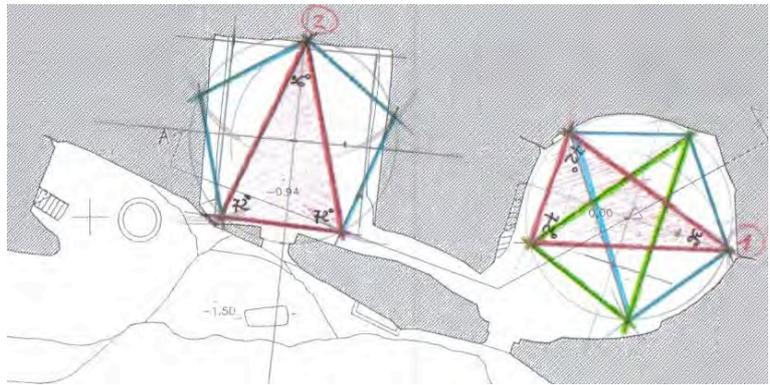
Gurfa. Pianta piano terra con “geometria aurea” sovrapposta, 1 e 2 sono le “absidi” a muro
